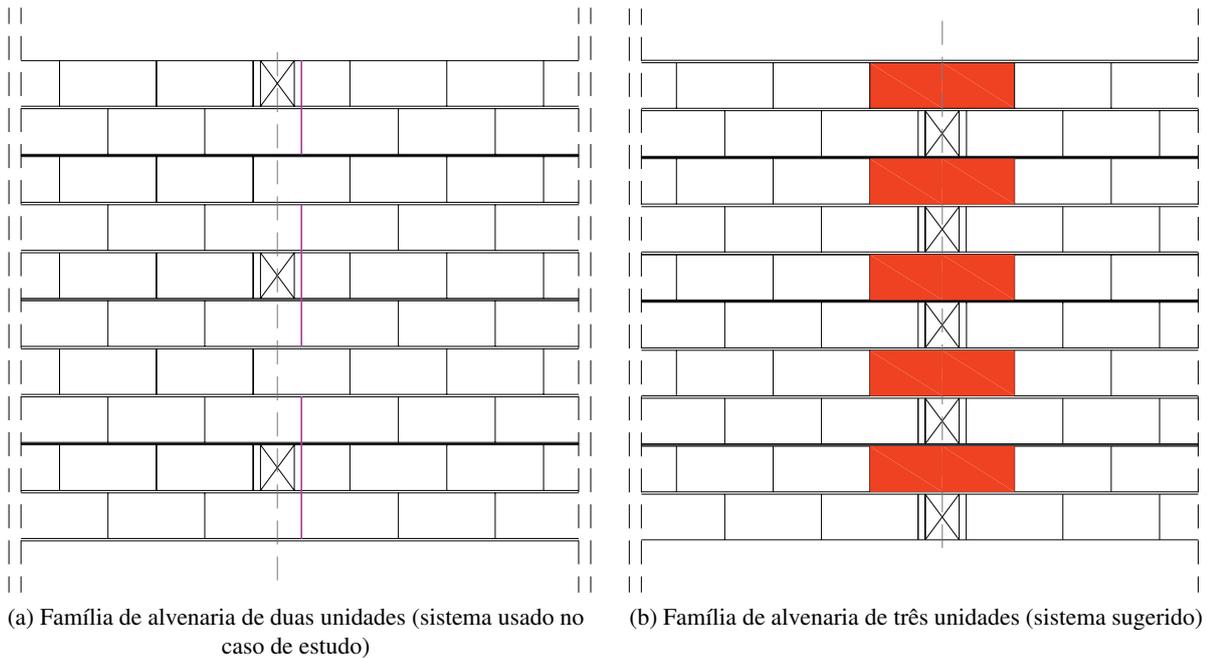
Pormenor em alçado de travamento de parede contraventada
